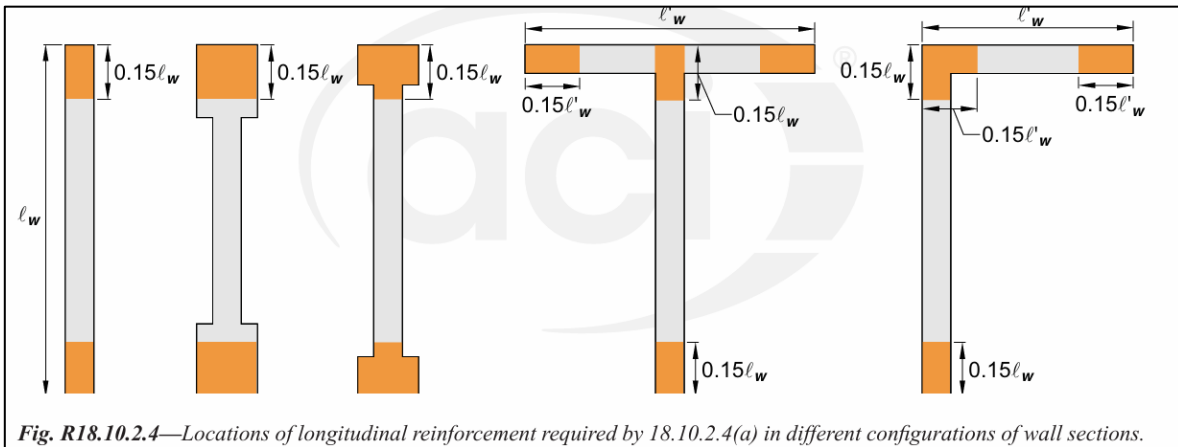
Longitud Para Acero de Refuerzo en los Elementos de Borde
